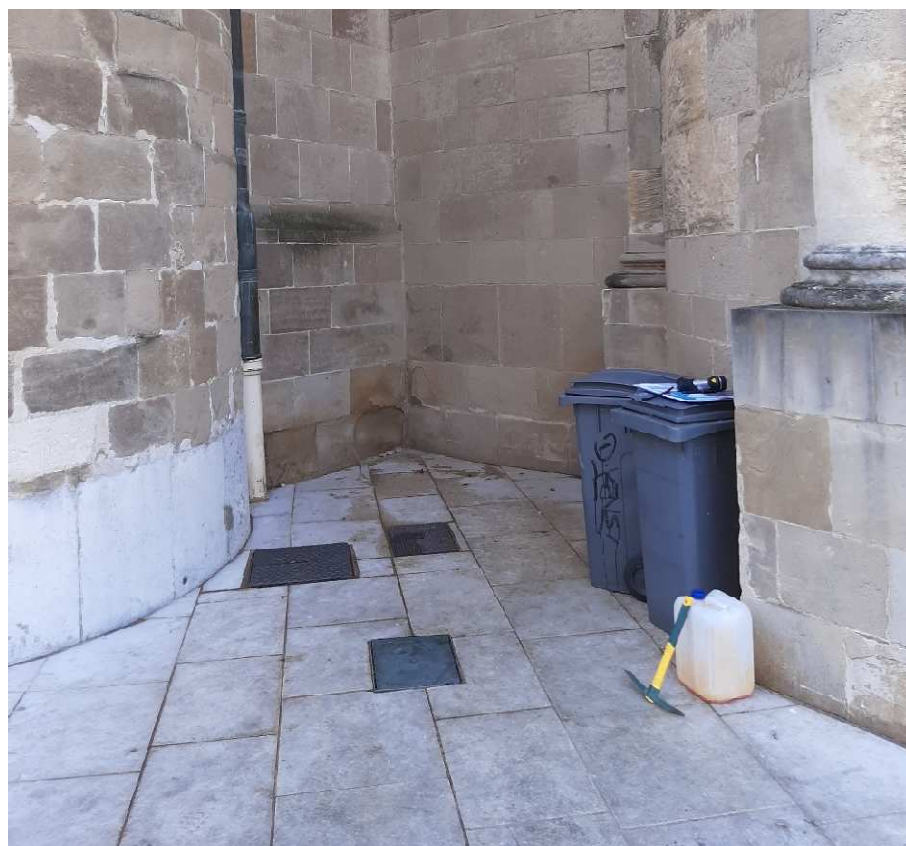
Photographies des gouttières et boîtes de branchement façade Est.
